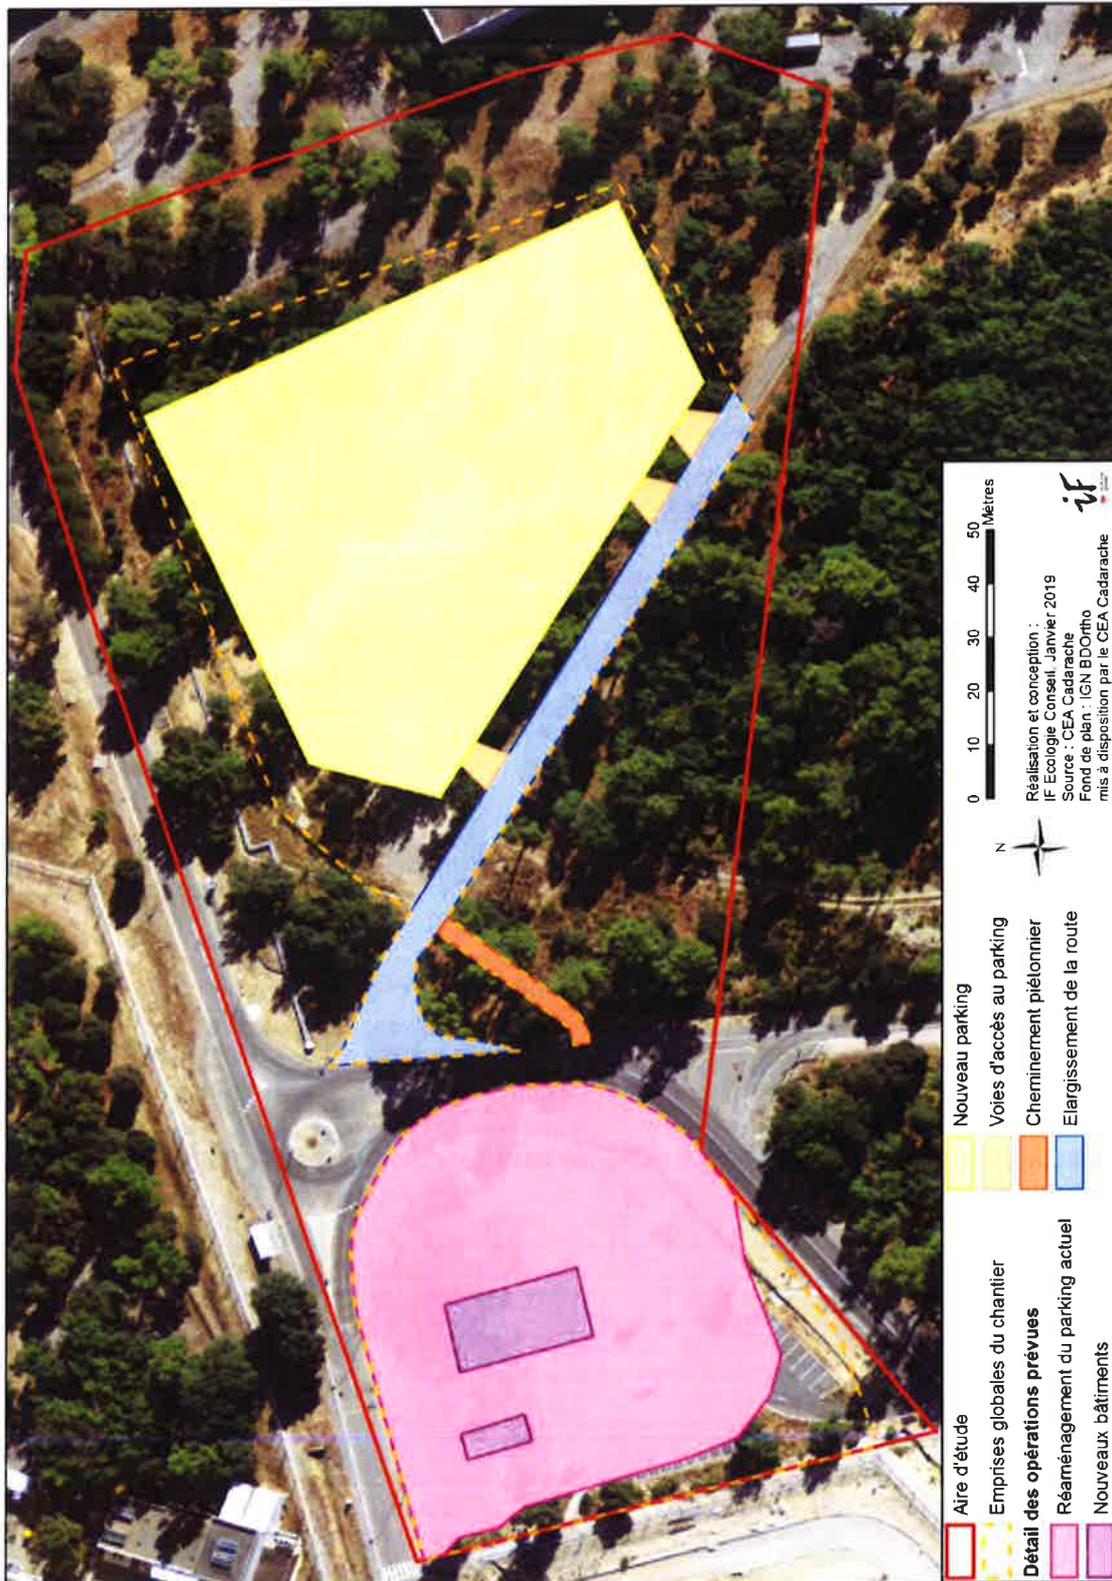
Plan d'implantation de l'aménagement (source : CEA)
